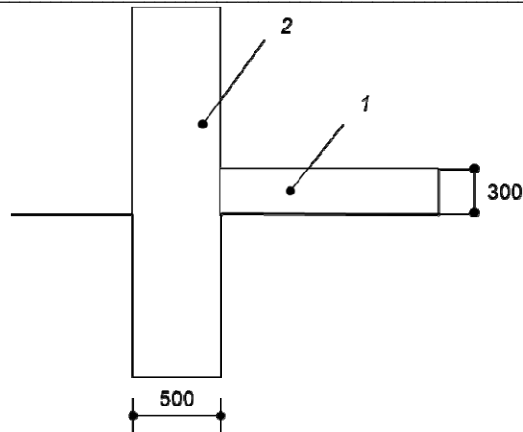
Схема базового узла без теплоизоляции: 1 — плита пола; 2 — стена фундамента
